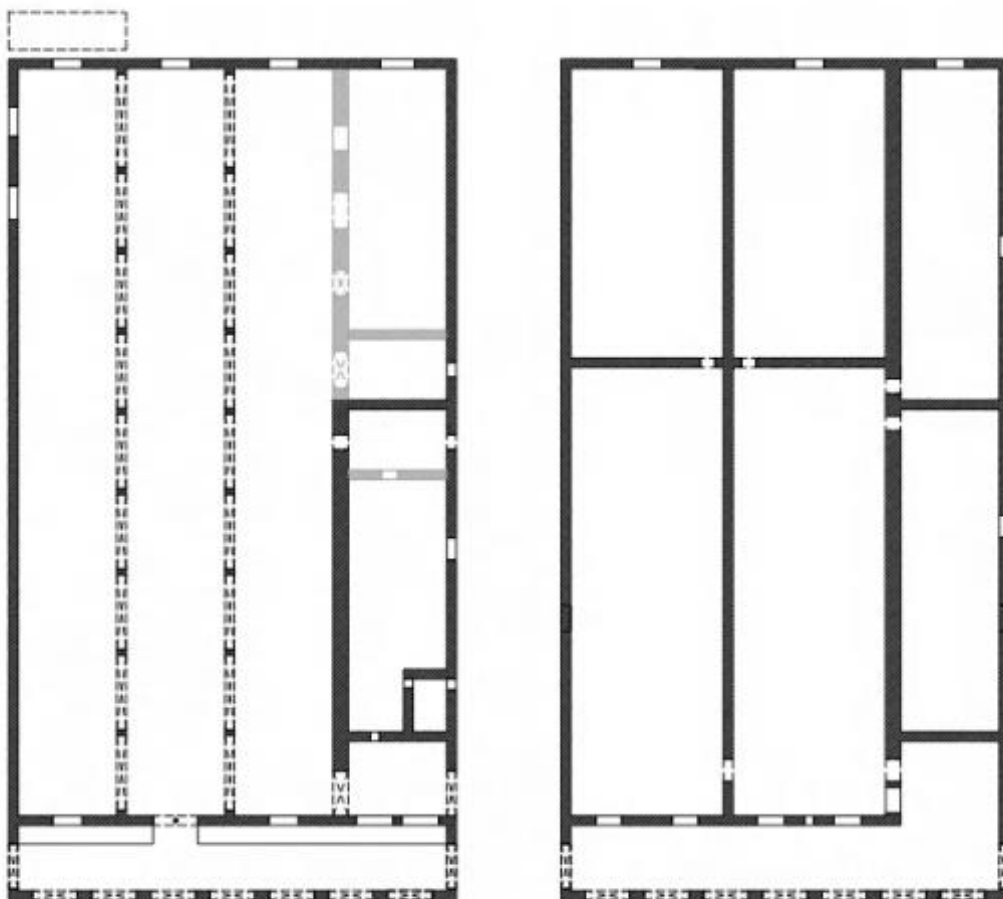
Reconstituição hipotética da planimetria da Casa da Câmara de Setúbal (piso térreo e piso nobre)
